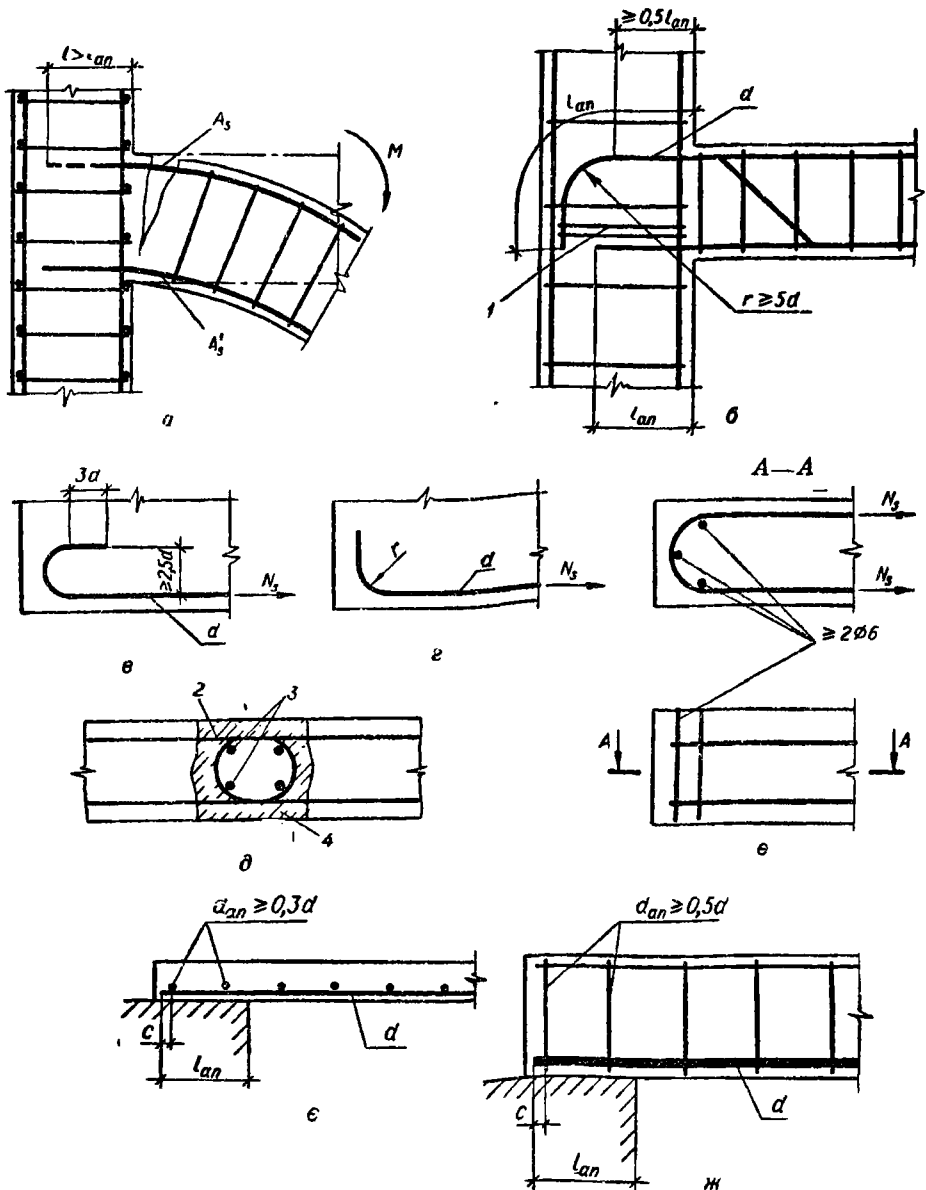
Анкерування розтягнутої арматури без попереднього напруження:
